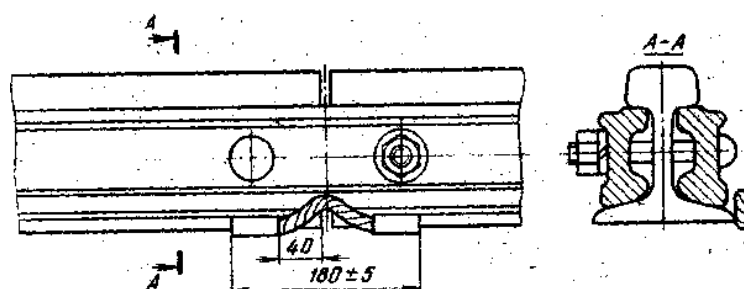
Соединитель, приваренный к боковой кромке подошвы объемнозакаленного рельса типа Р50.
